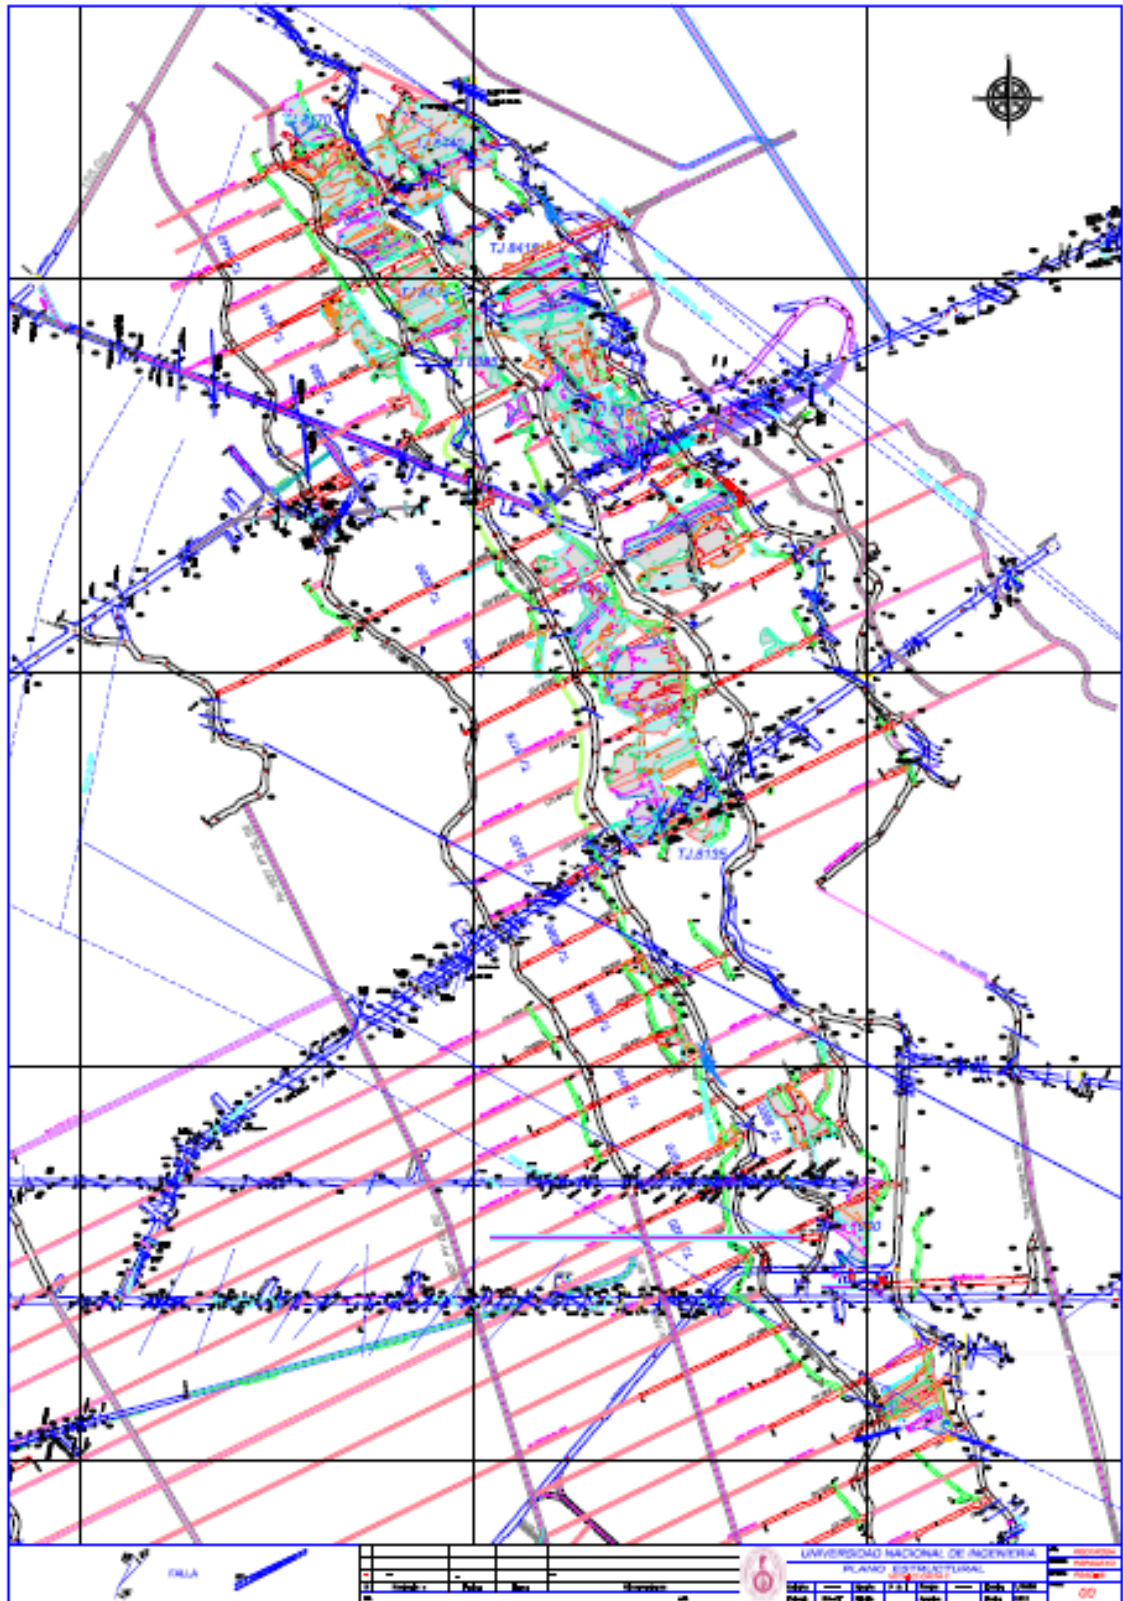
, Plano de Glorita 2 con las Estructuras principales (ver Plano N° 1 en el anexo).
